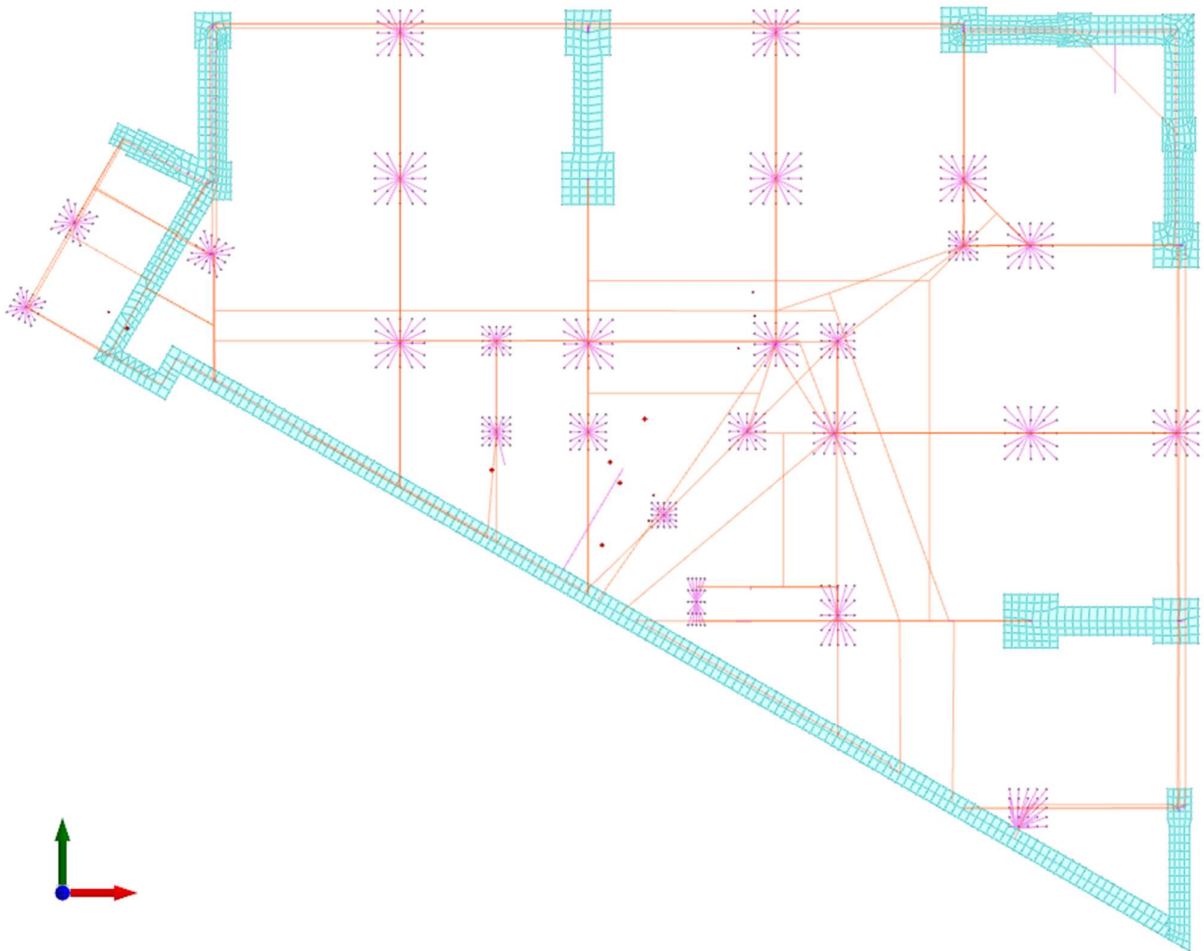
Modello STATO DI PROGETTO (verifica portanza fondazioni) – pianta delle fondazioni
